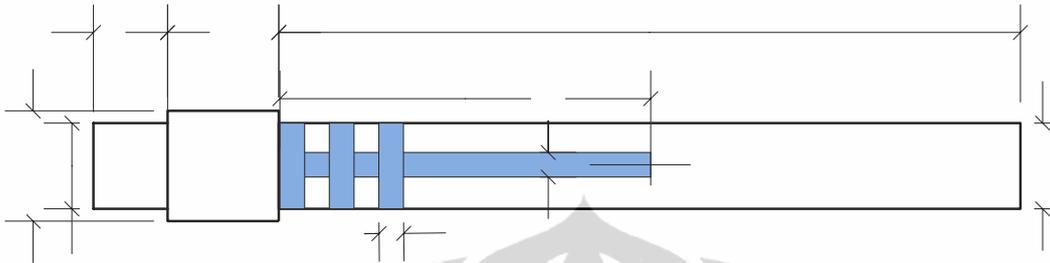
Tampak Atas Pemasangan CFRP pada Balok
